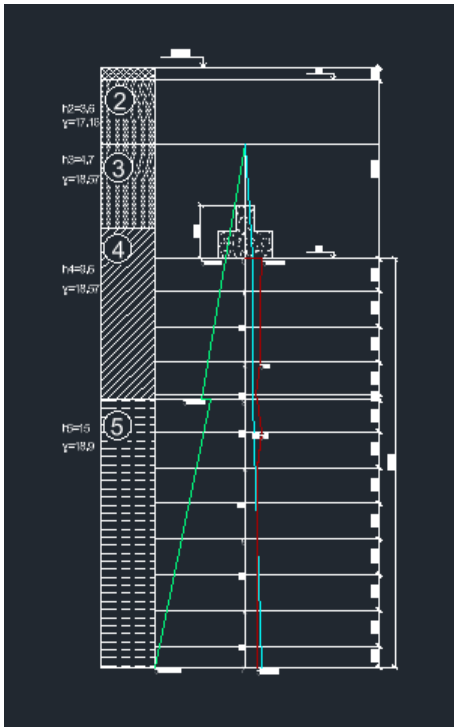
епюри напруг фундаменту ФМ – 1
